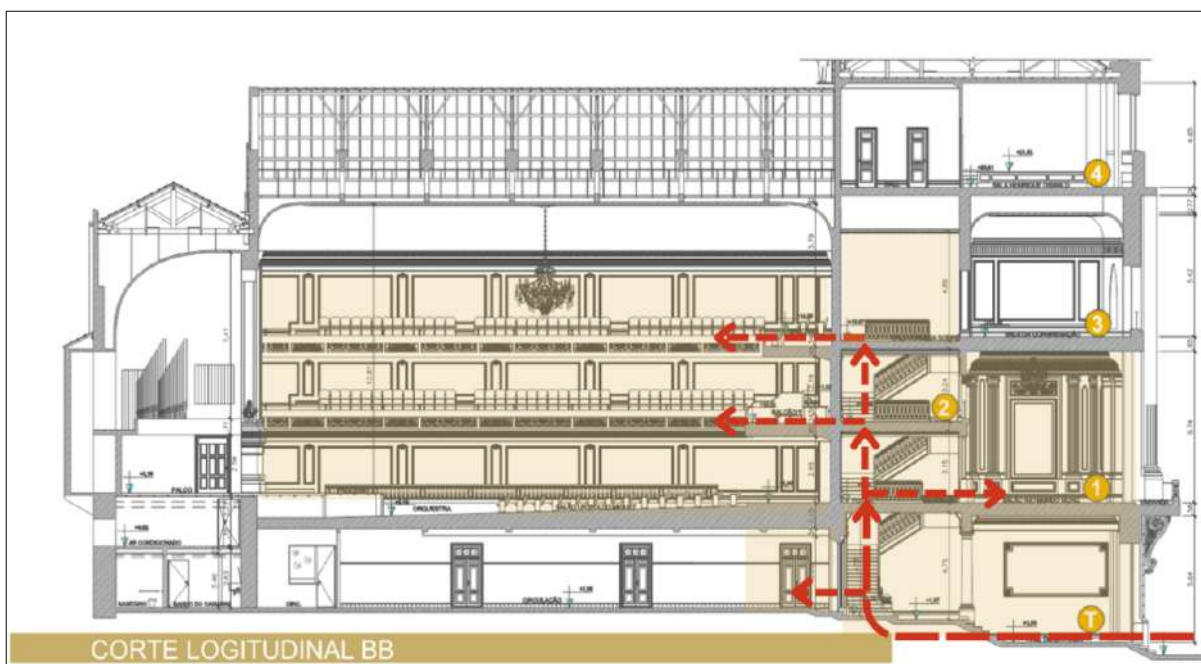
Fluxo térreo, 2º, 3º e 4º pavimentos da EM.
